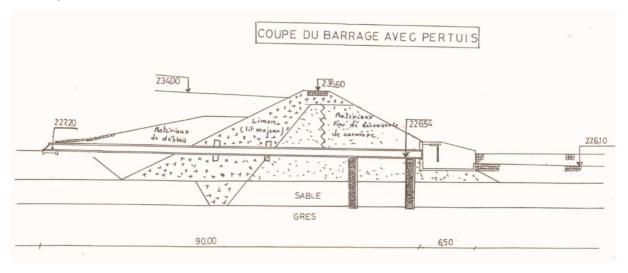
Vue en coupe du barrage du Grentzbach. Source : Dossier d'ouvrage du barrage de Grentzbach à Diemeringen, 2012, SAFEGE
